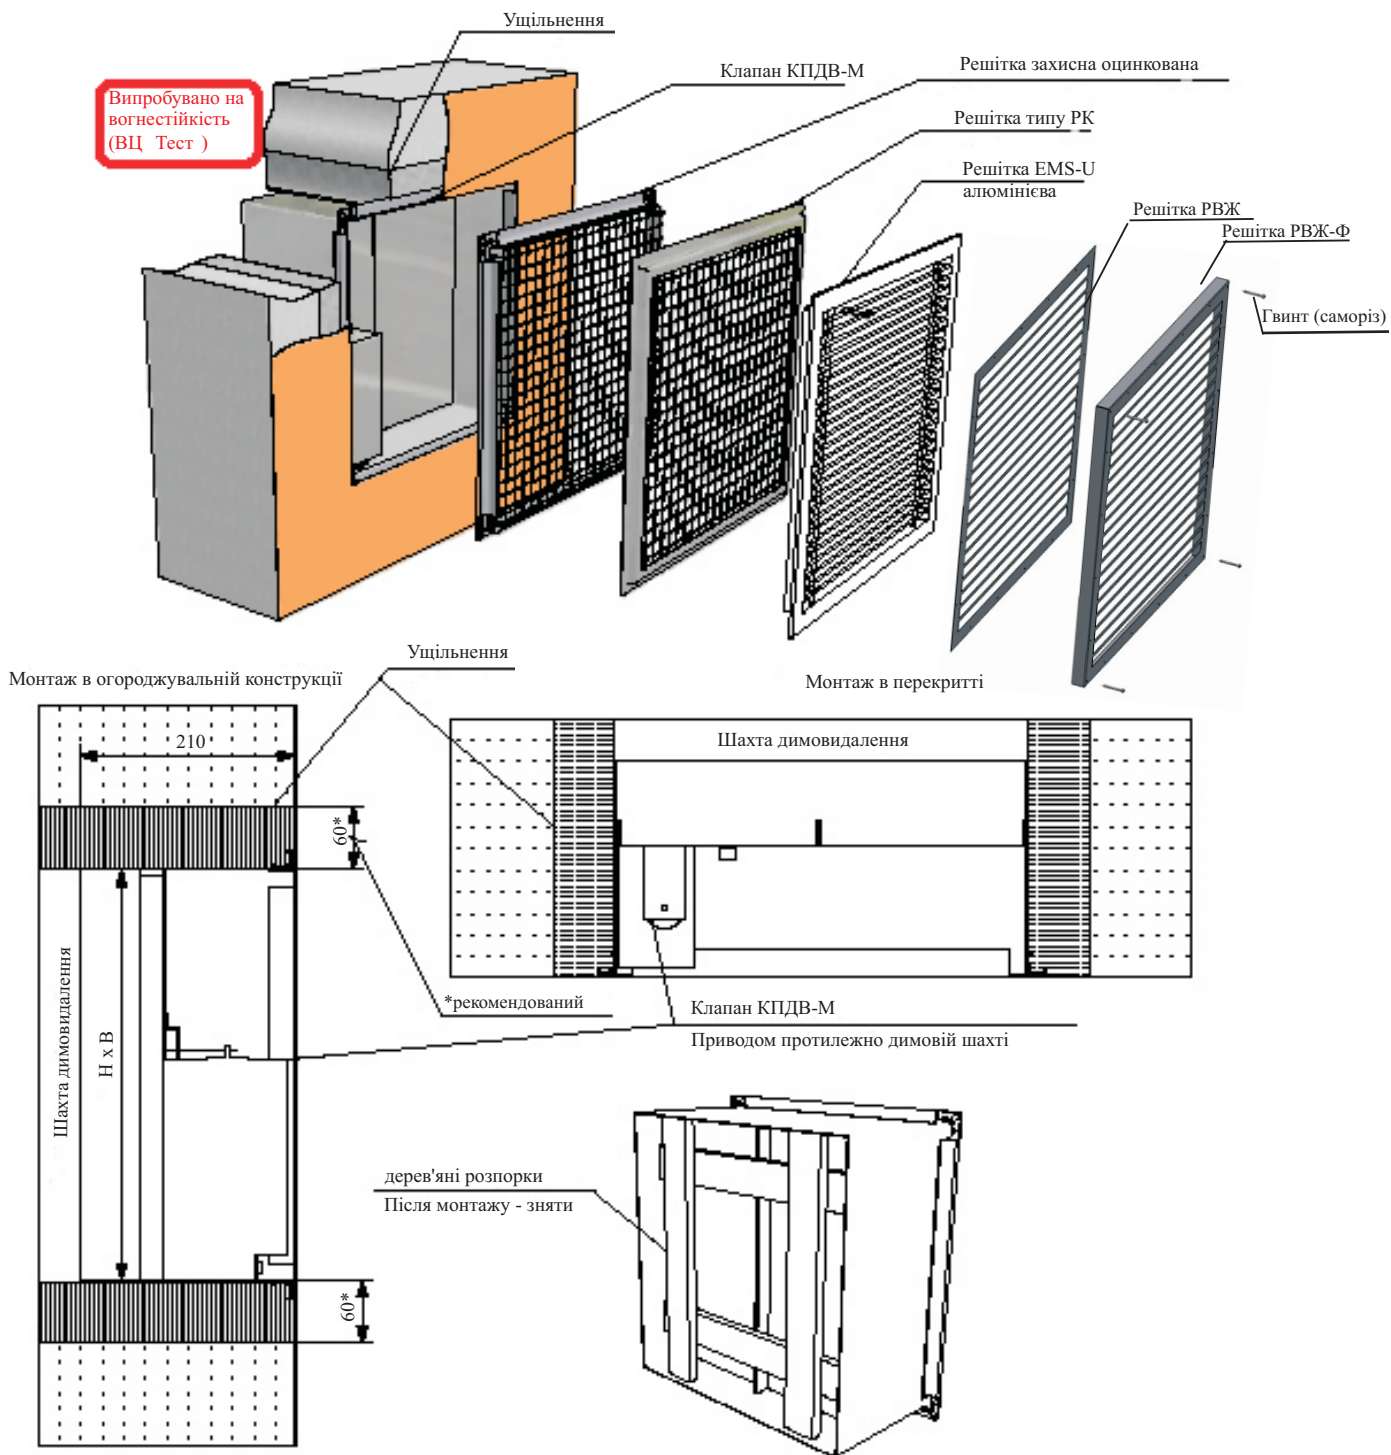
Схема монтажу клапана КПДВ-М з бетонним закладенням
